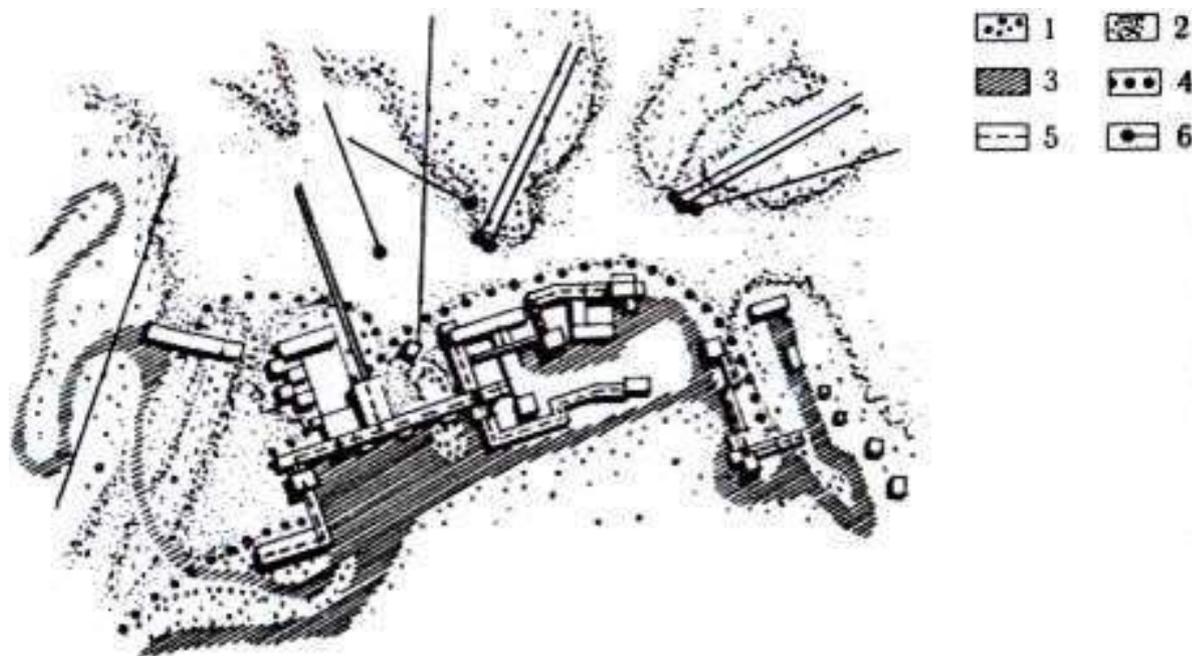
Генплан горно-рекреационного комплекса «Ла Плань»:
